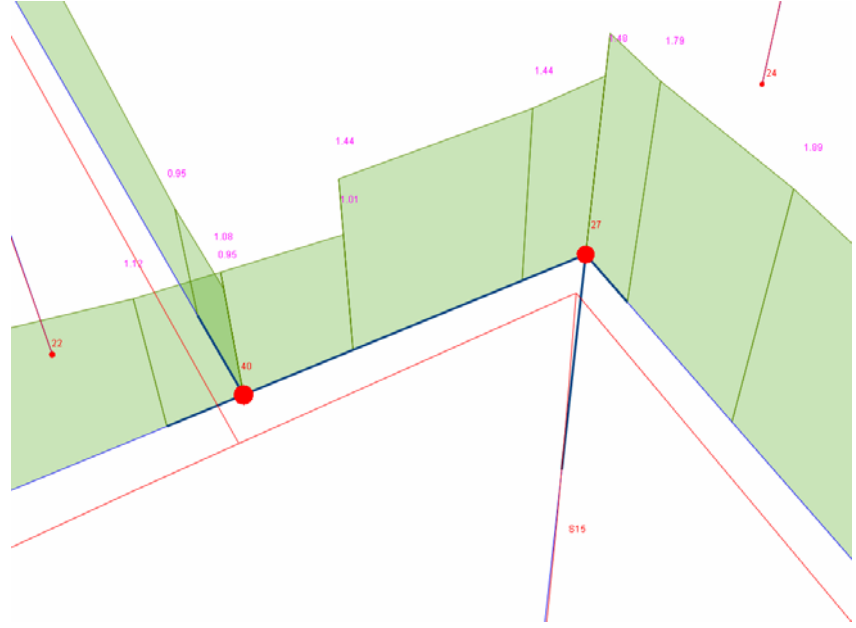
Kiriş Bölgesiyle tanımlanmış plak döşeme
